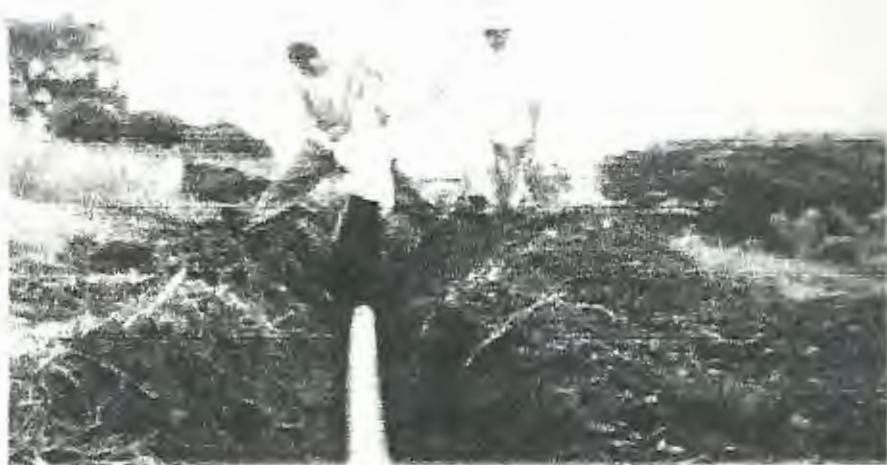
RELLENO DE ZANJAS Y CUBIERTA DE TUBERÍAS.
